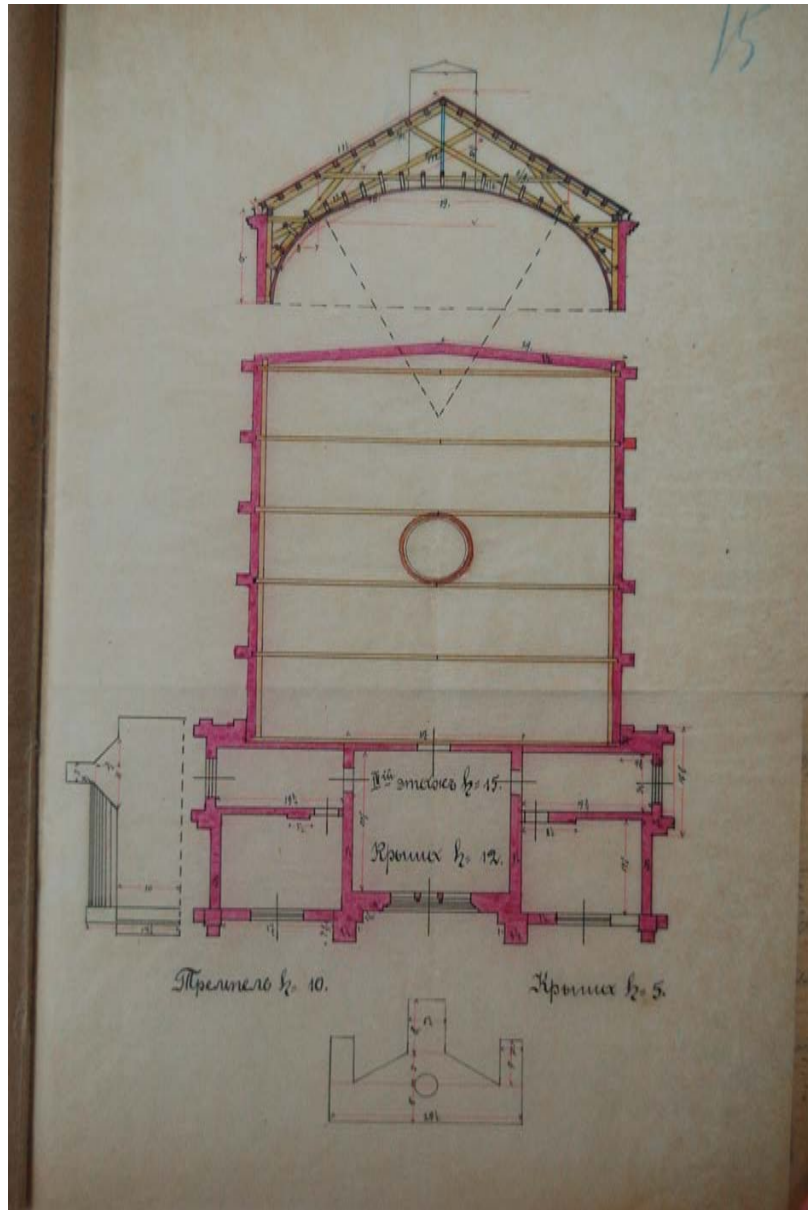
Grundriss 2. Obergeschoss, Archiv
